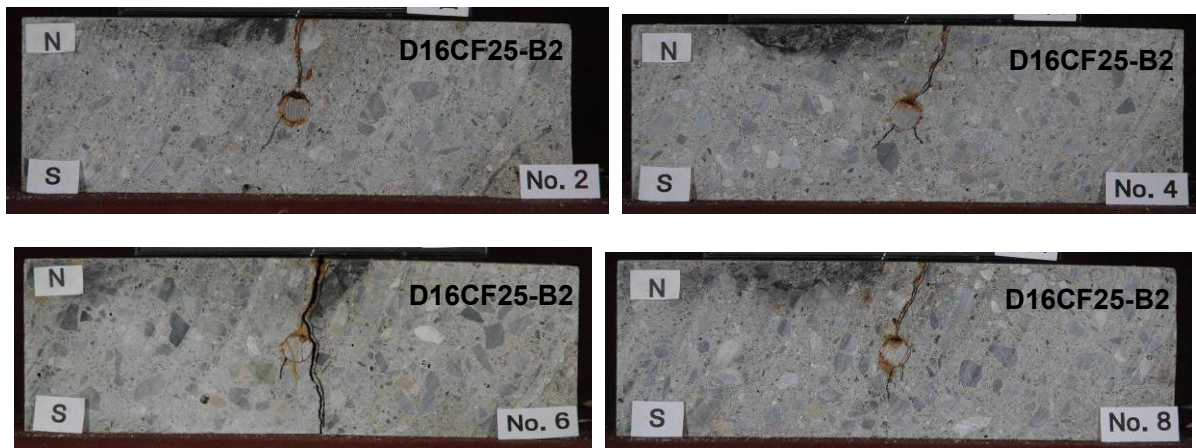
D16CF25-B2 の腐食ひび割れ状況
